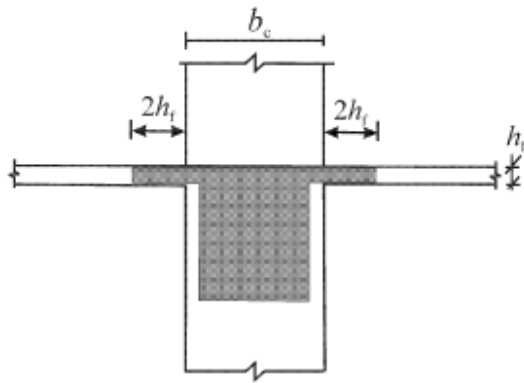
Largura efetiva do banzo de uma viga ligada a um interior, sem viga transversal
